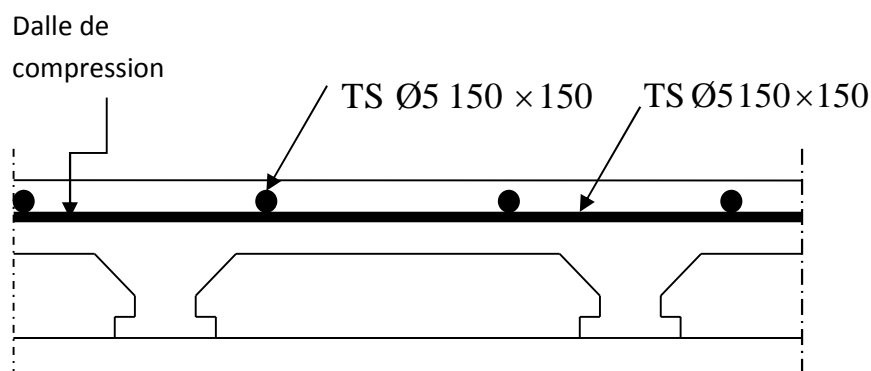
Schéma de ferrailage de la dalle de compression.
